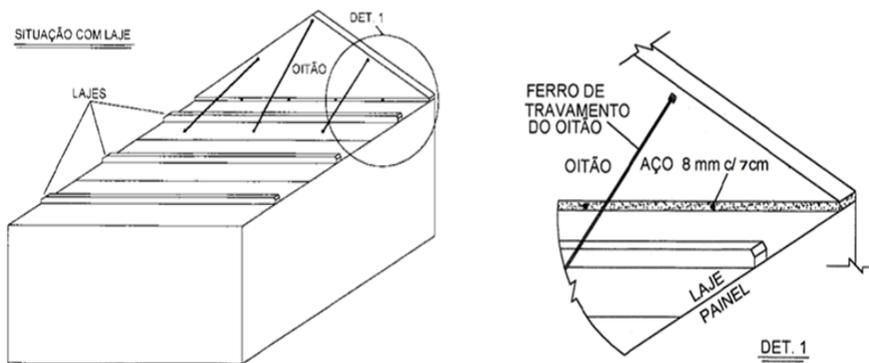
Esquema do posicionamento do painel de oitão, apoiado na laje de forro
